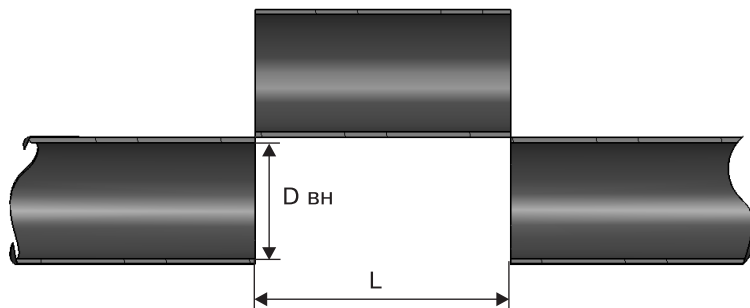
Схема вырезки трубопровода для установки расходомера
